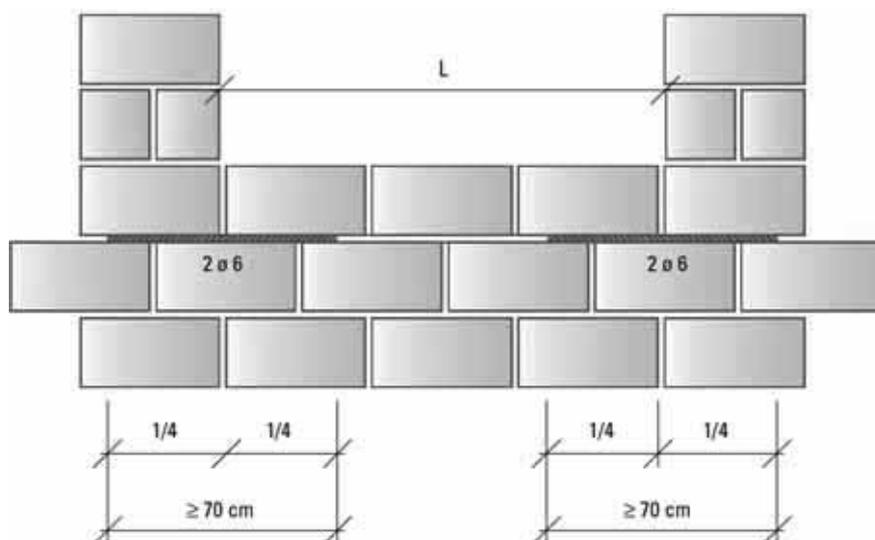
Refuerzo bajo jambas con armadura de tendel.
